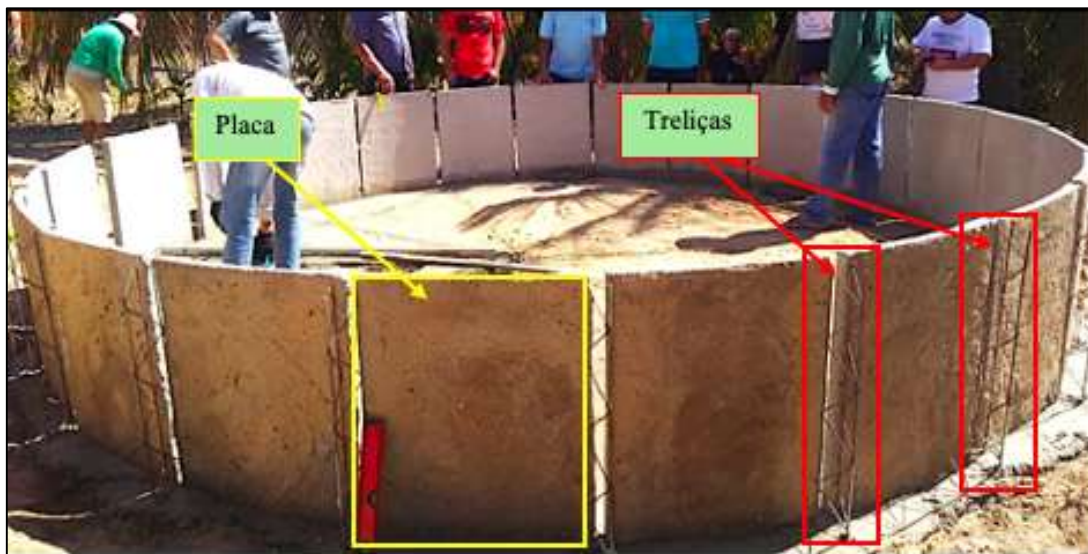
Montagem, alinhamento e travamento de placas e pilares (Fonte: acervo pessoal do autor).
